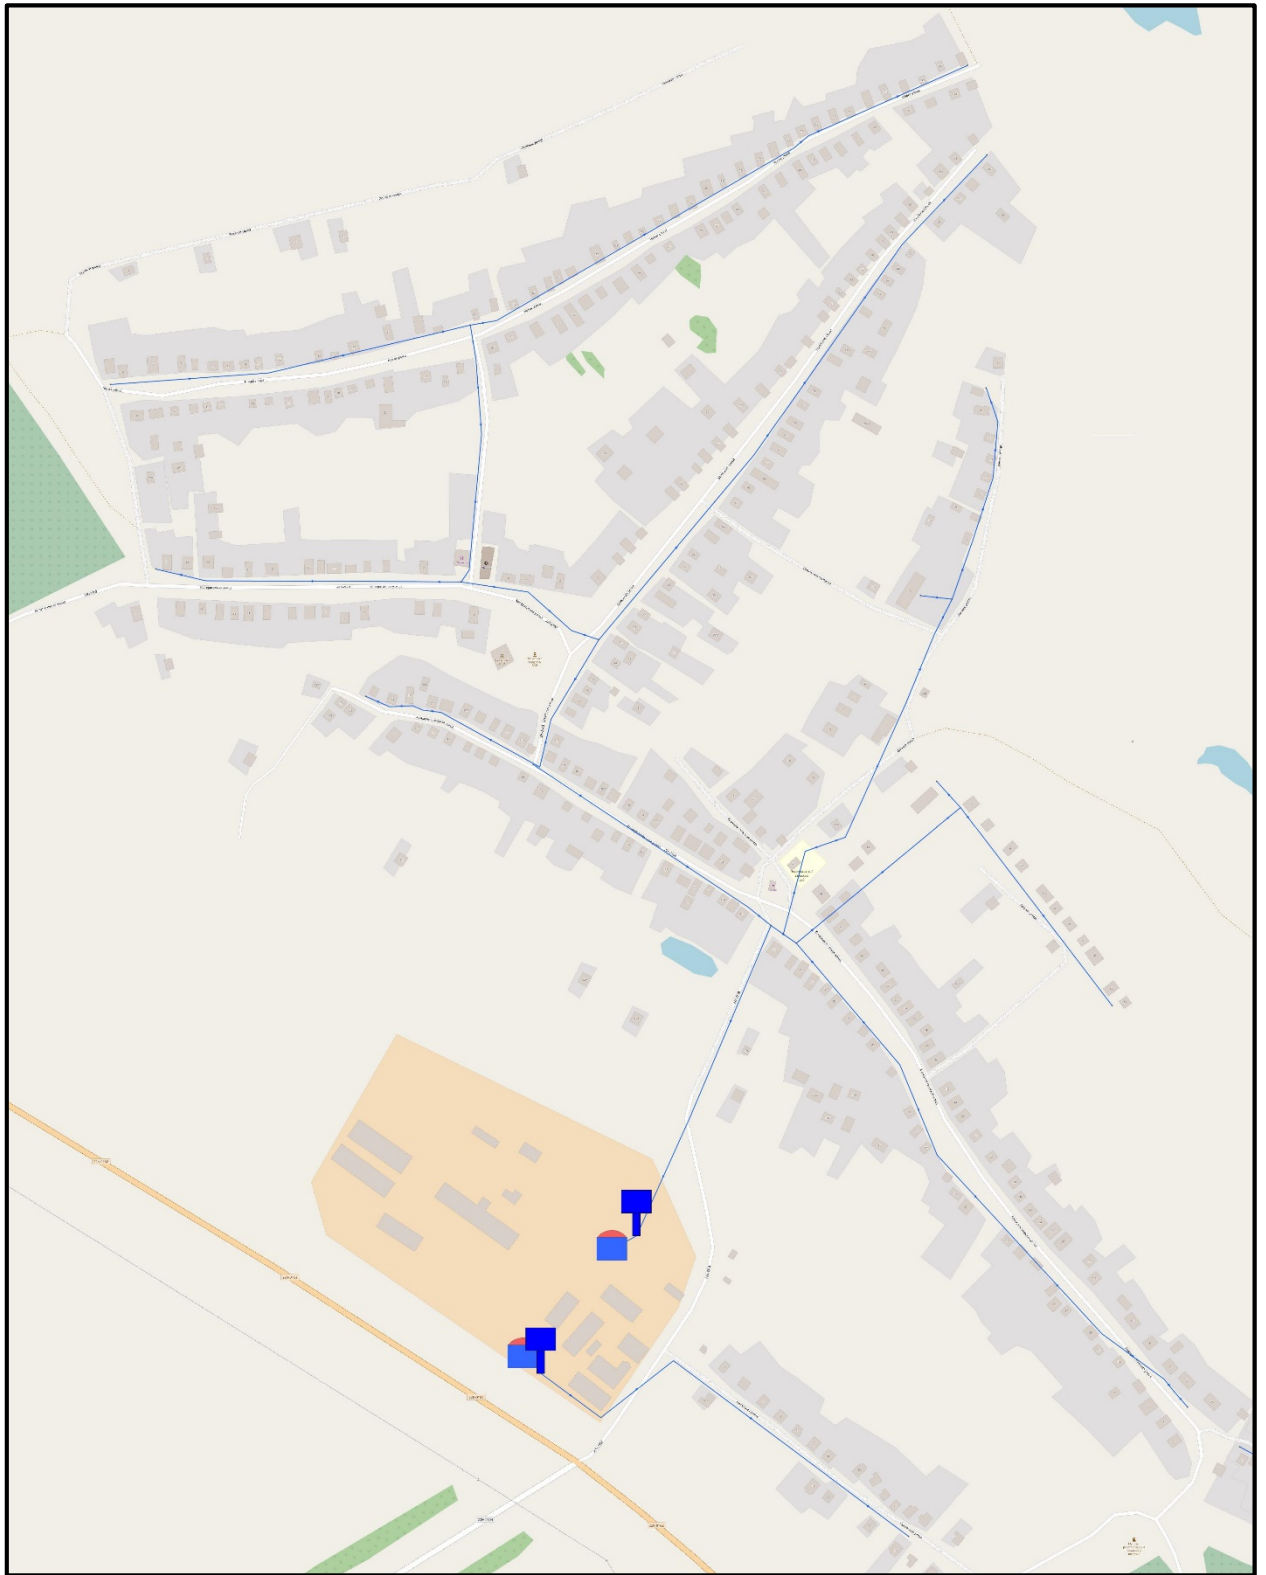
Схема водоснабжения д. Пошатово
